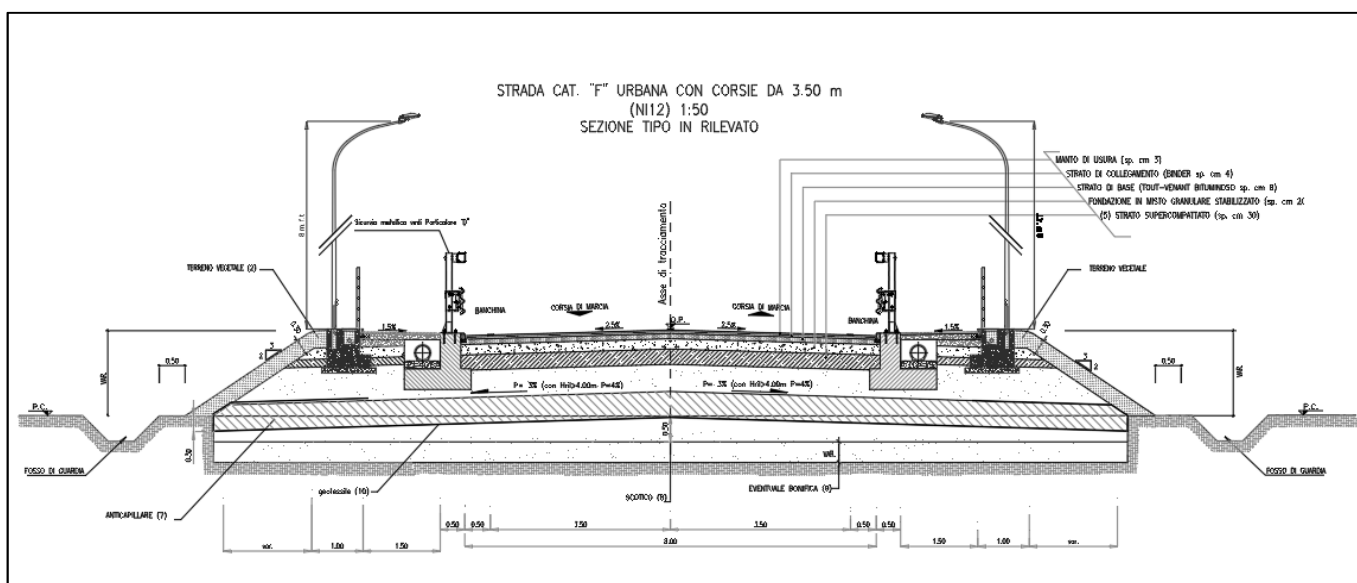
Sezione tipo in rilevato. Categoria F in ambito urbano
